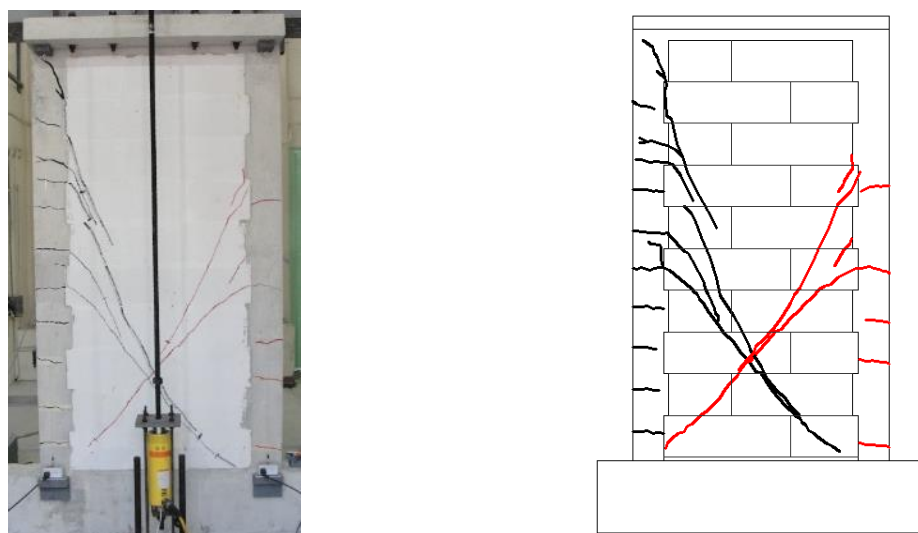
Primer agrietamiento diagonal del muro Mc3
